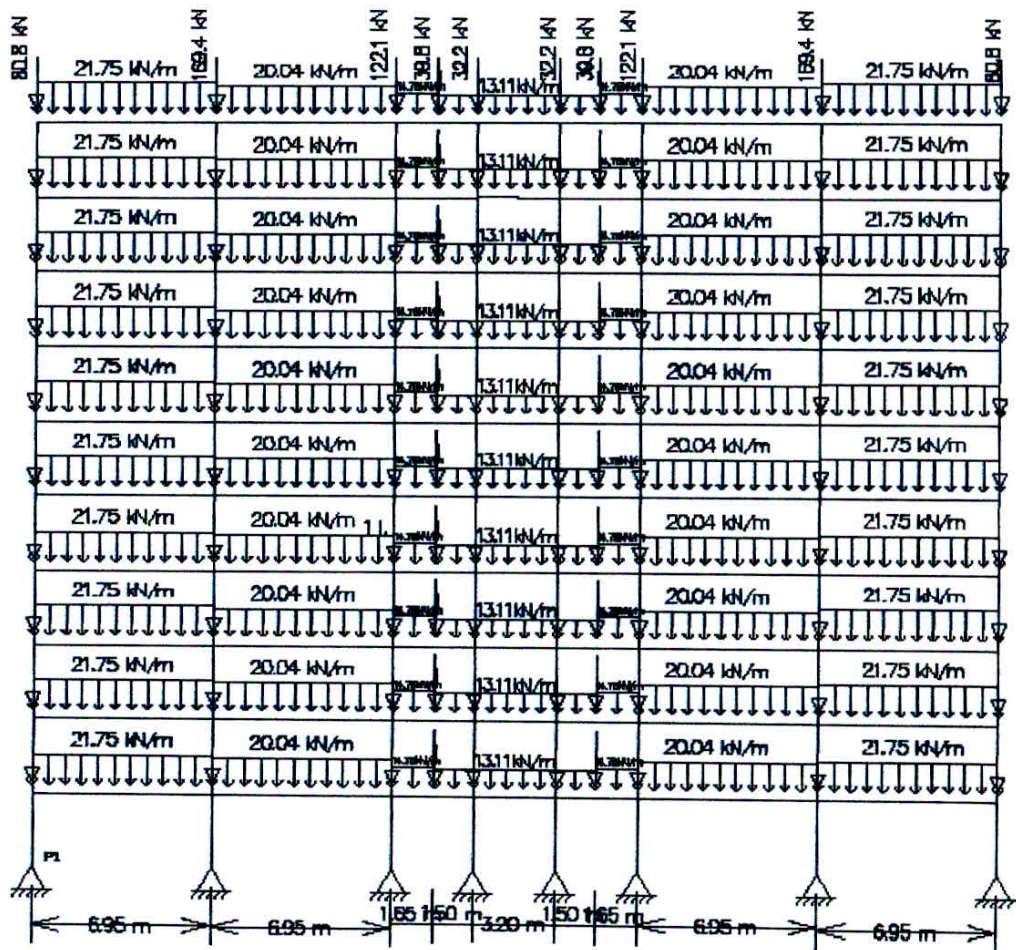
Pórtico P1 Longitudinal, Carregamentos finais.
